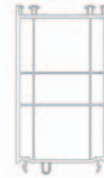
Einbauvariante 70 mm KBE und Kömmerling
